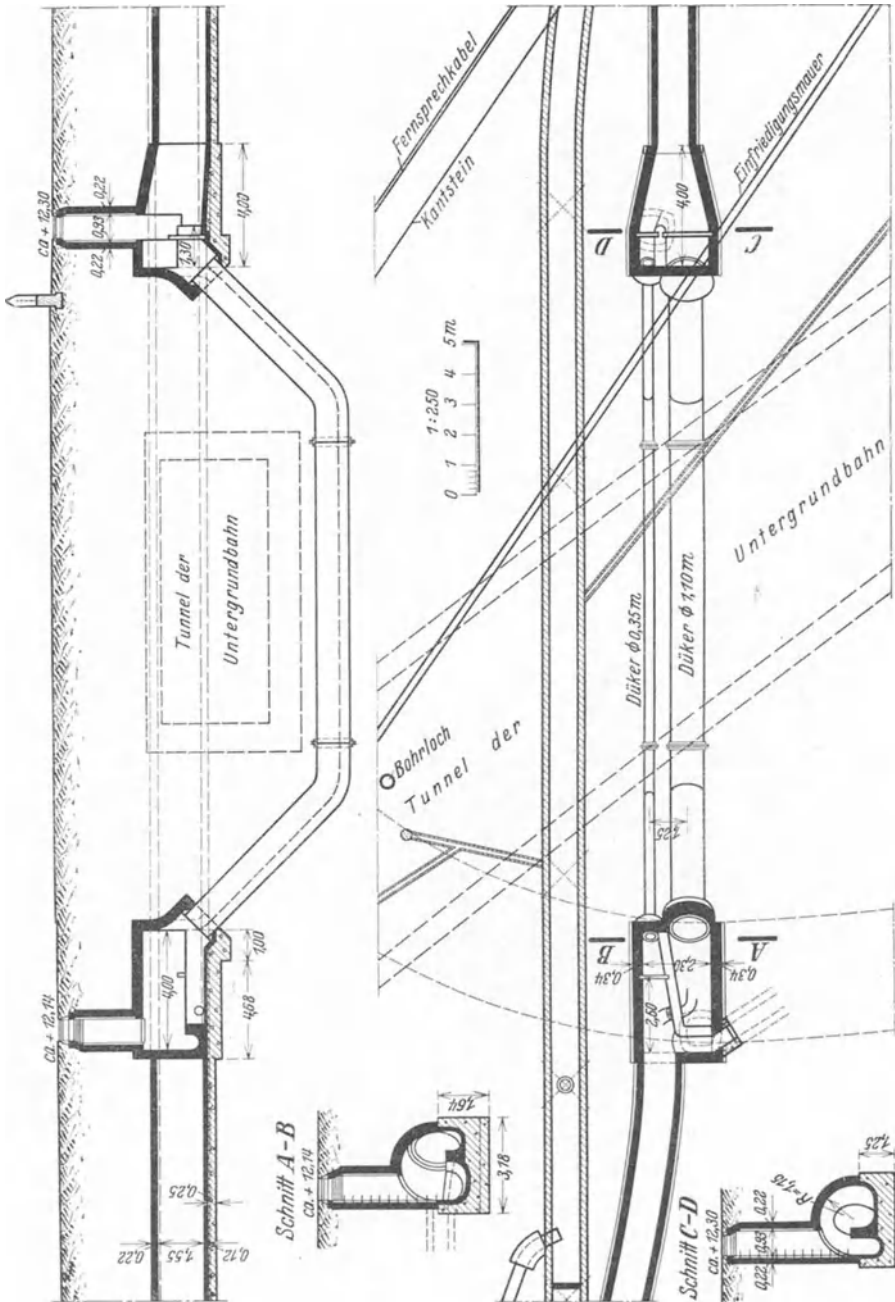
Düker unter der Hamburger Untergrundbahn.
